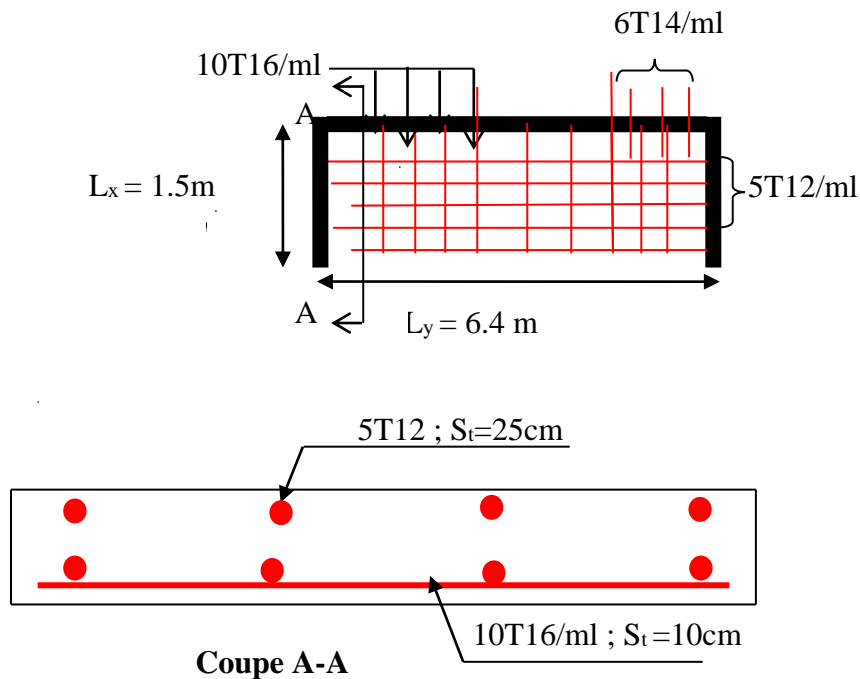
Schéma de ferrailage de la dalle sur 3 appuis (D2)
